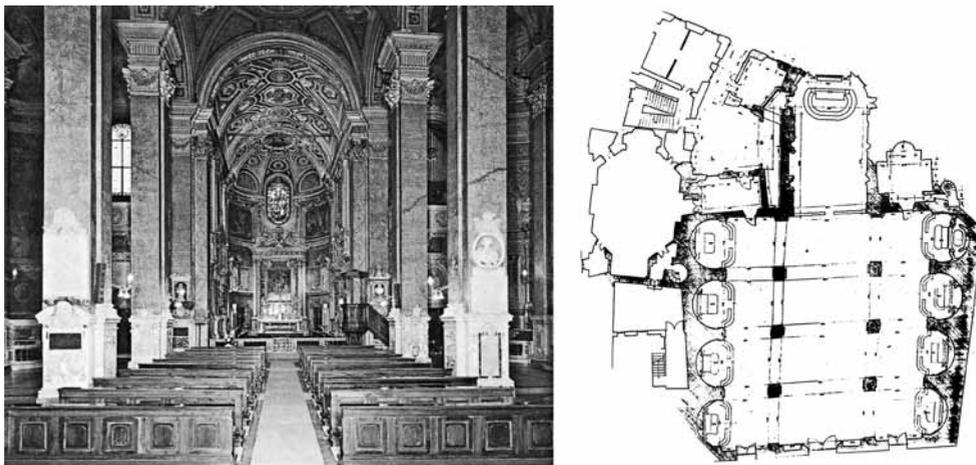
Igreja de *Santa Maria dell'Anima*, Roma (Itália): vista geral da nave e capela-mor; planta
